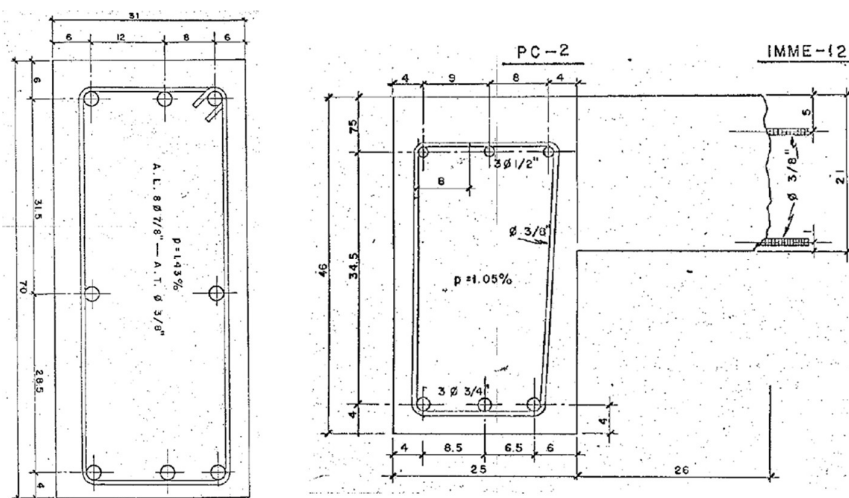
Disposición de acero en columnas de PB y una viga. [4]
